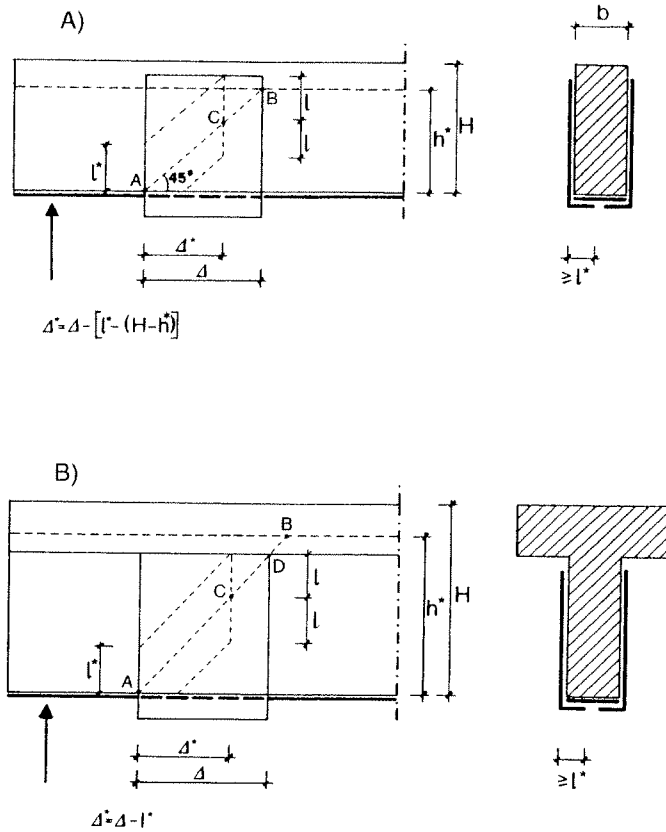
Calcolo di armature di rinforzo a taglio: A) per trave a sezione rettangolare; B) per trave a sezione a T.
